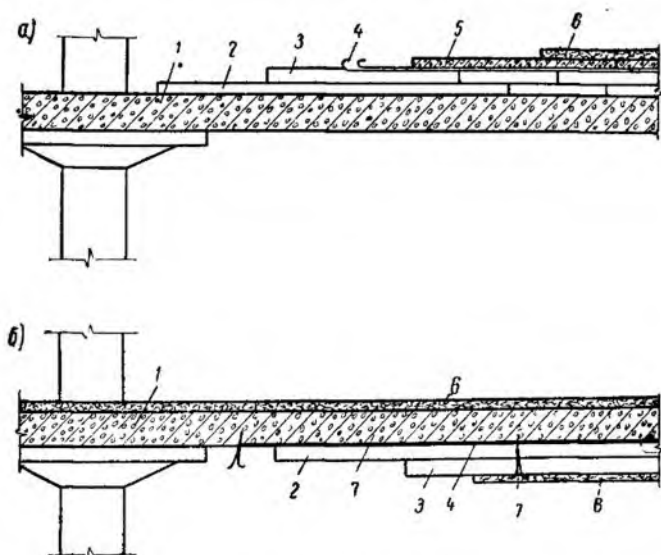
Изоляционные конструкции междуэтажных перекрытий:
